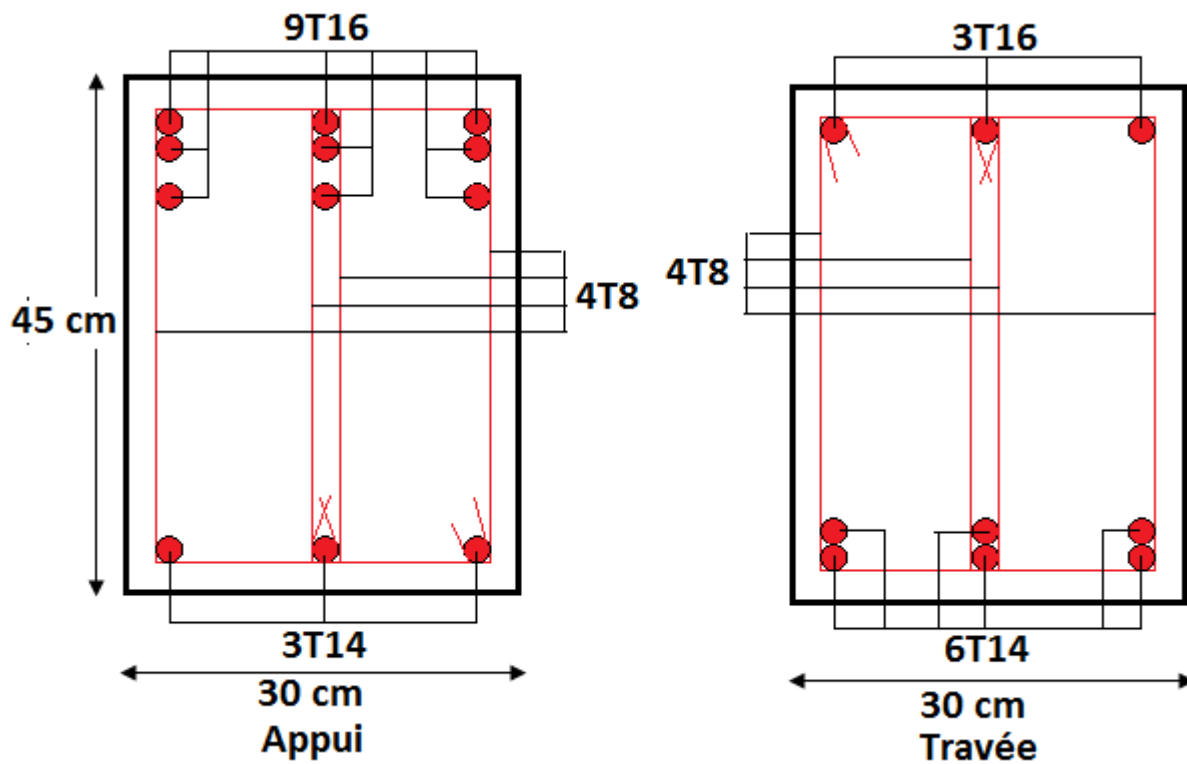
Ferrailage de la poutre (A) de RDC.
